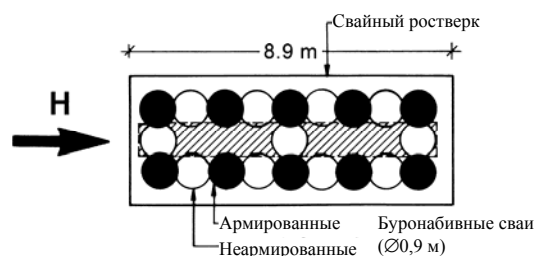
Фрагмент плана коробчатого фундамента опоры моста. Фундамент, состоящий из трех коробов, подвергается большой горизонтальной нагрузке, поскольку слабые грунты сжимаются под давлением насыпи. Подобные фундаменты можно устраивать и на неустойчивых склонах
